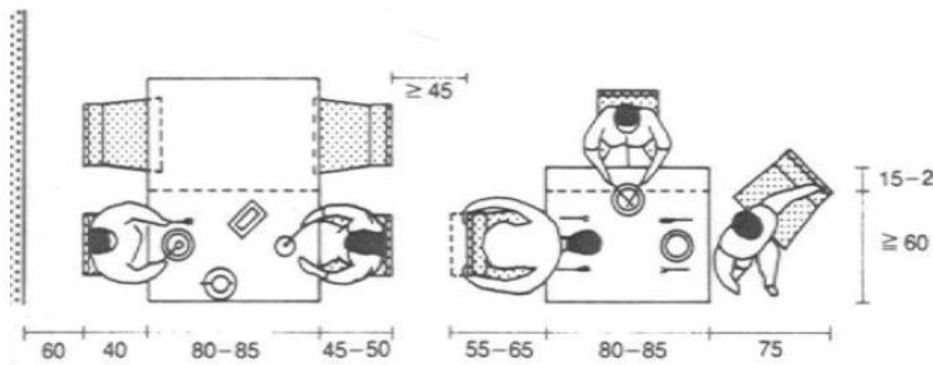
Esquema dimensionamiento mesas restauración [10]
